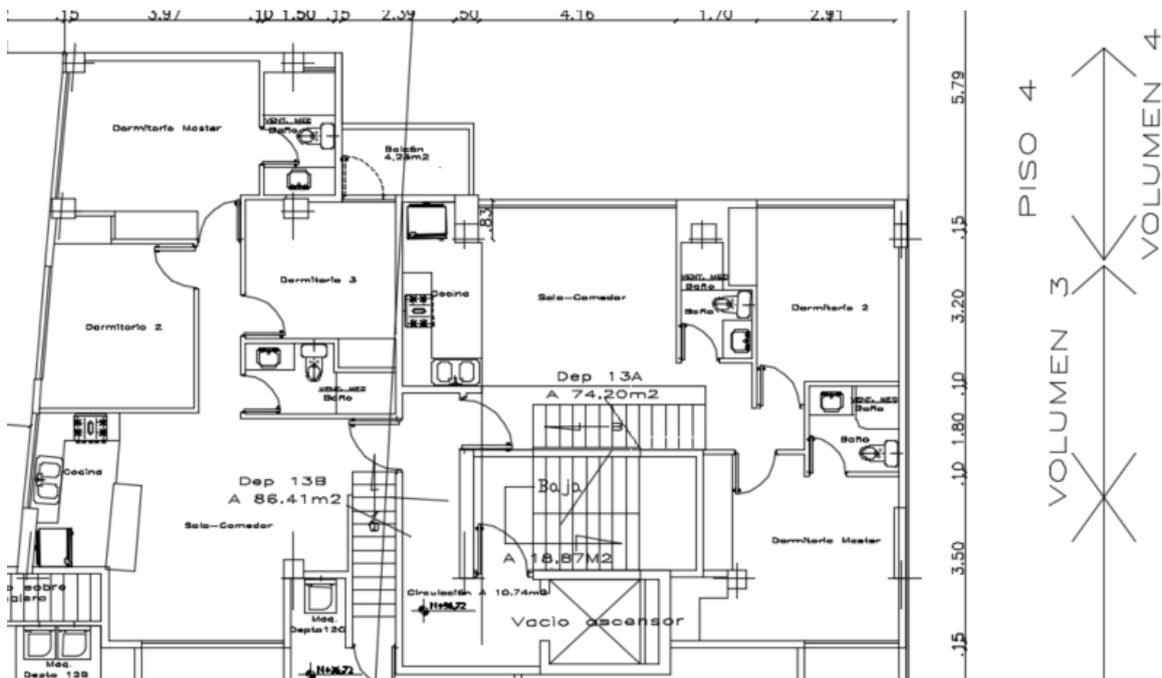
Vista en planta del piso 13 de IDM4.
